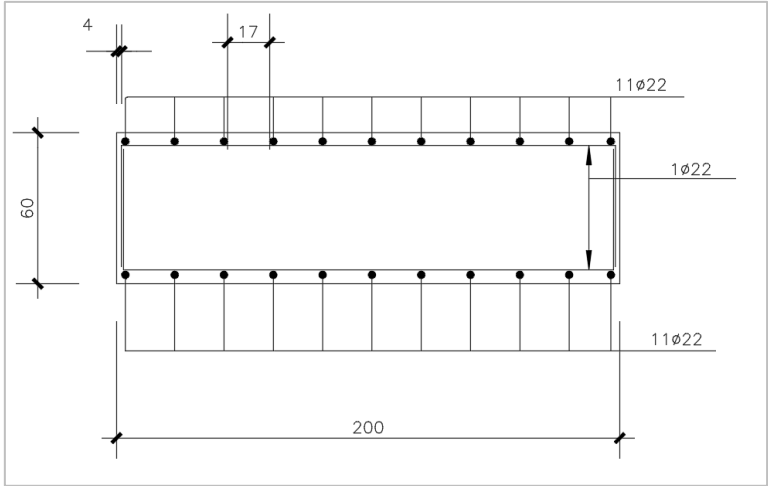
Detallamiento corte B-B zapata, ESC: 1:50
